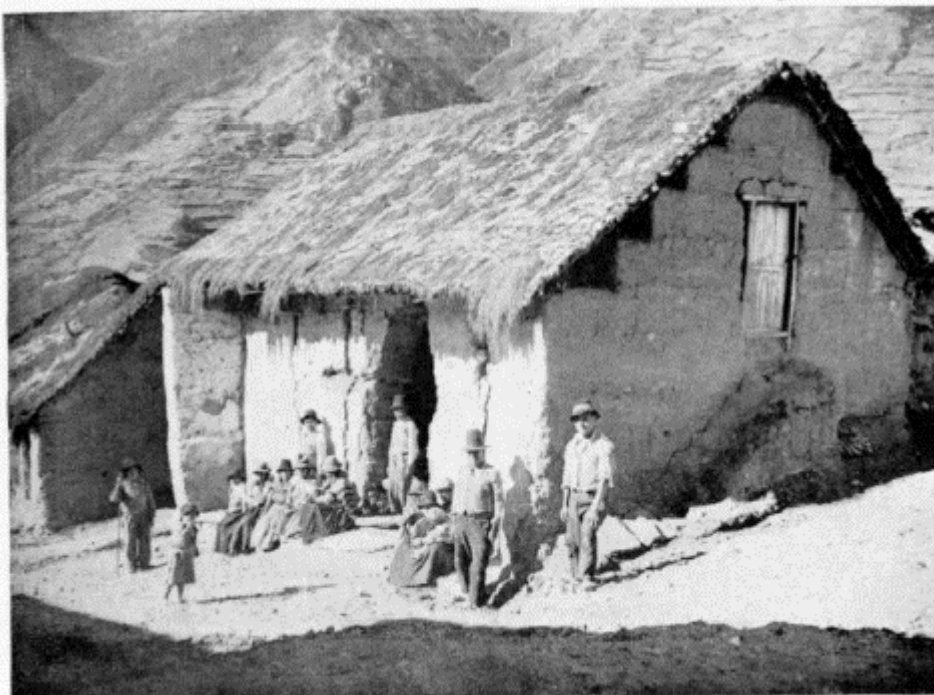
Vista de una casa típica de adobe, donde se observa rajaduras en sus muros.
